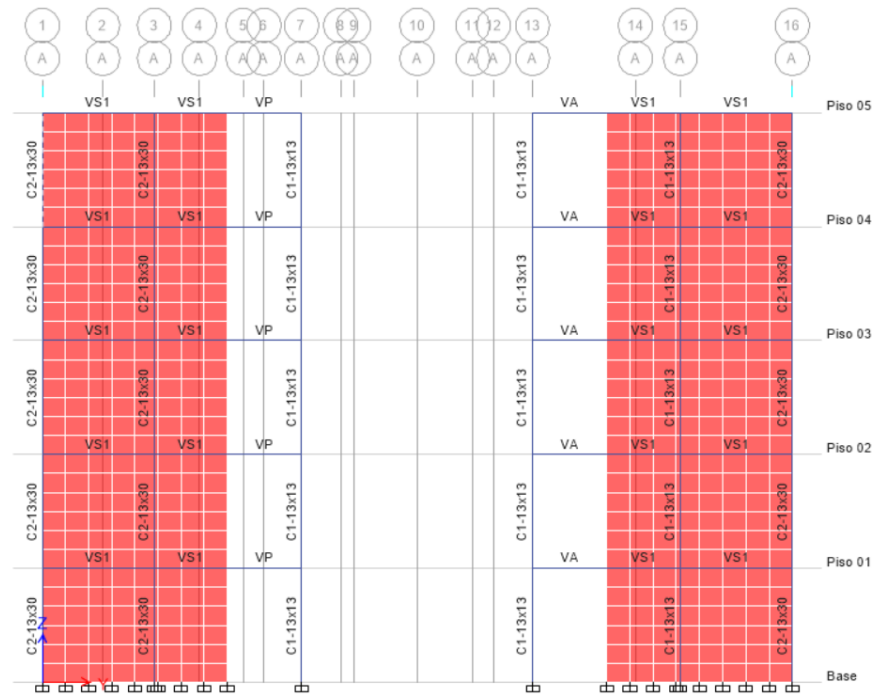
Vista en elevación de la vivienda multifamiliar analizada. En esta vista se muestran las columnas y vigas típicas consideradas en el diseño.
